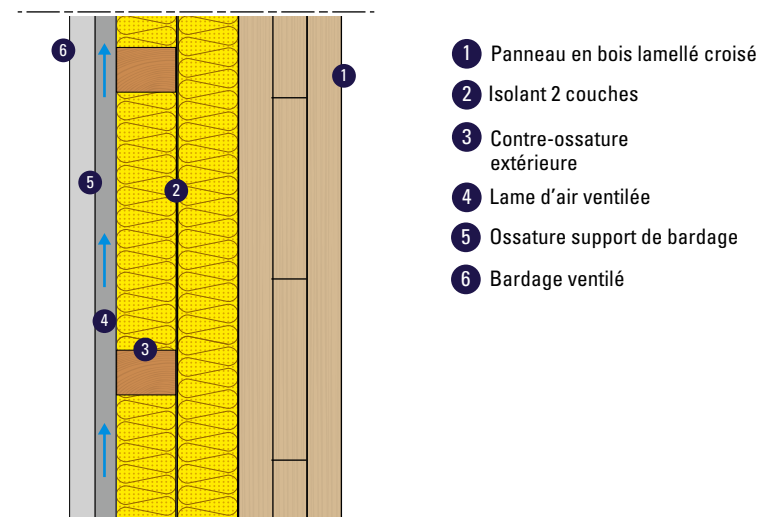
Paroi CLT isolée par l'extérieur avec système pare-pluie sur support discontinu (coupe verticale)
